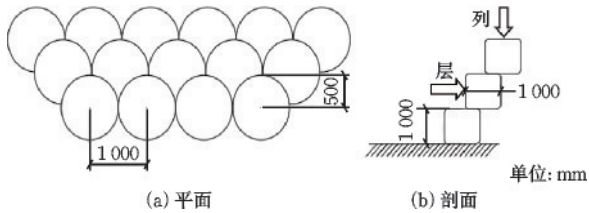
大体积土工袋挡墙的平面图和剖面图^[17]
